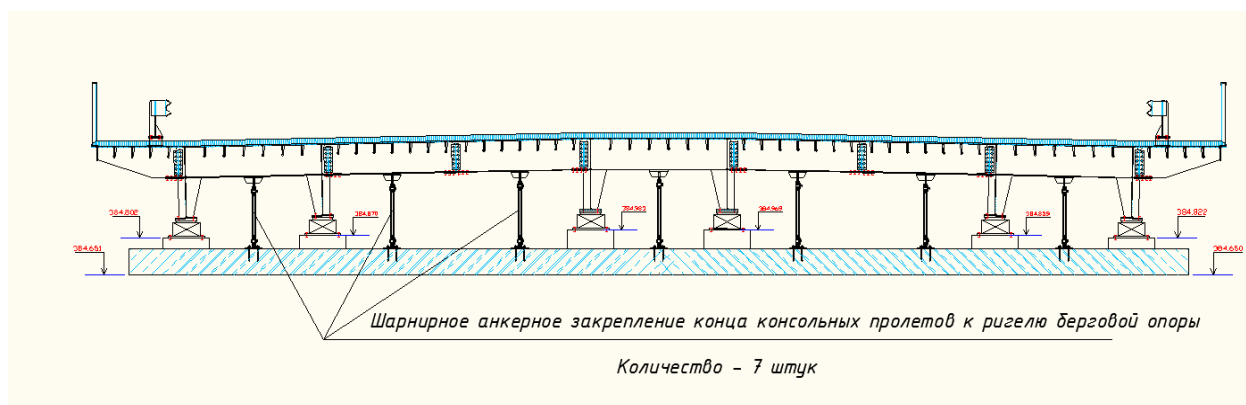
Анкерное крепление концов пролетного строения к насадке (ригелю) береговых опор
